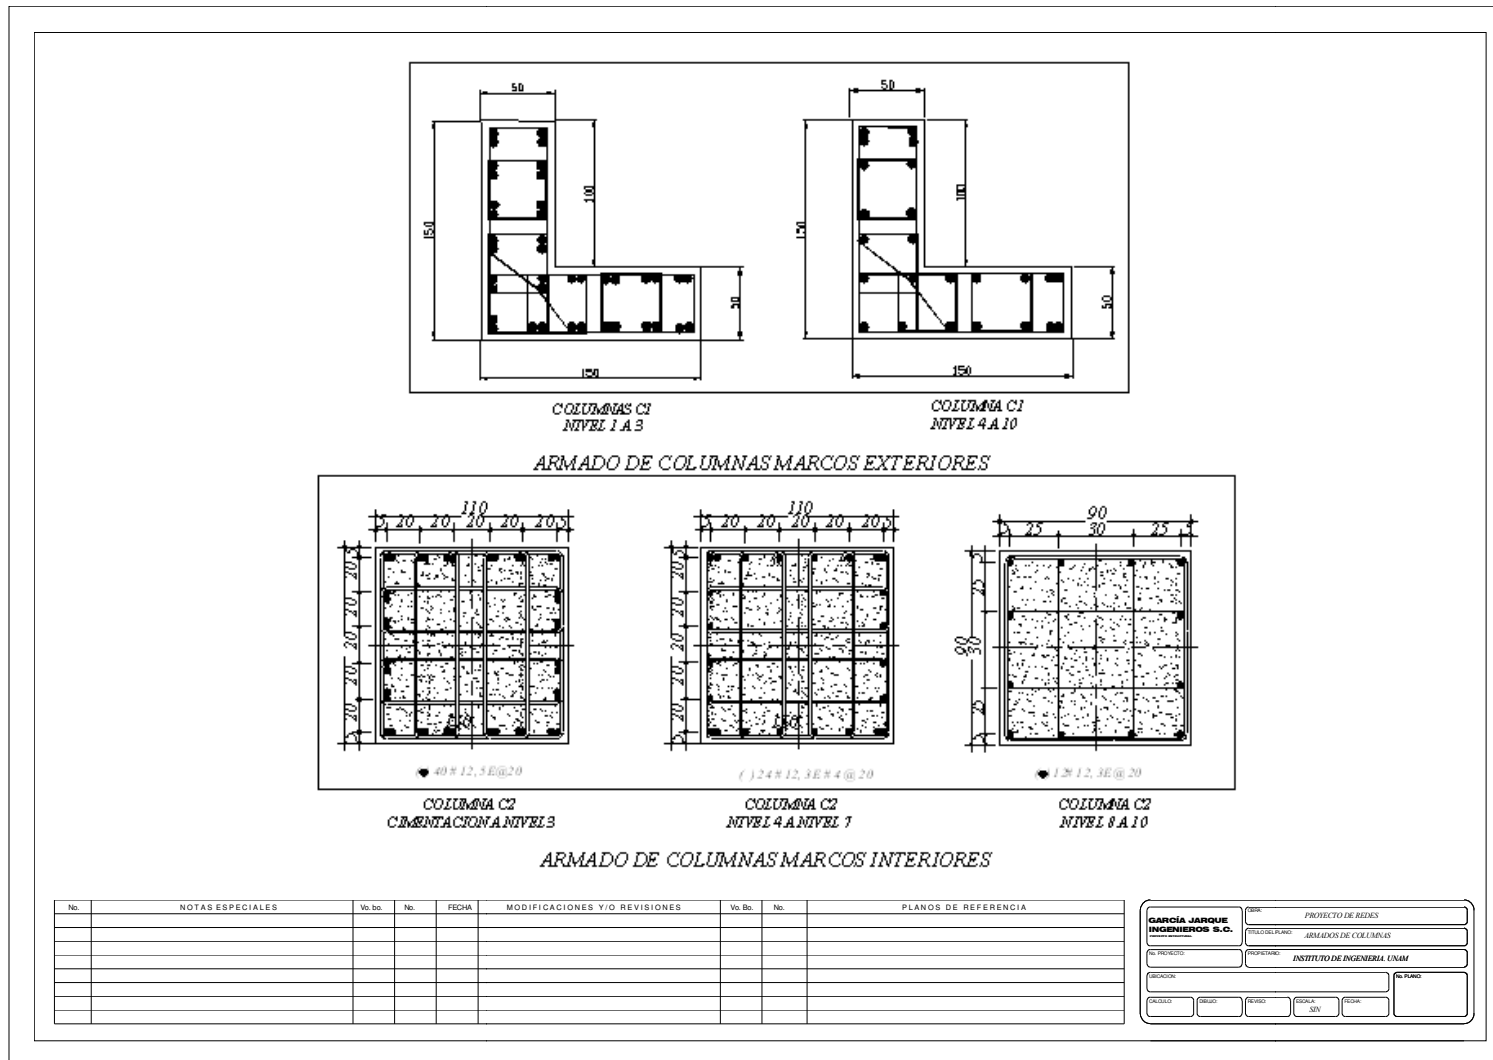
Secciones estructurales del edificio de 10 niveles
